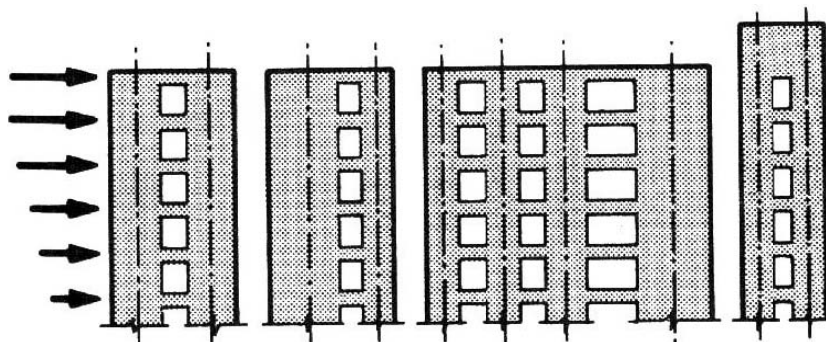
Tipos de muros estructurales acoplados [Paulay y Priestley, 1992]
